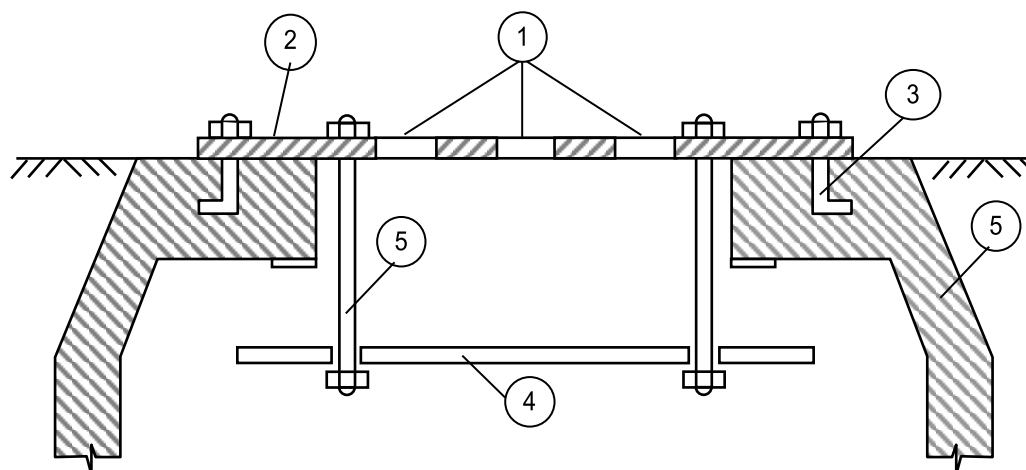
Схема блокирующего устройства: 1 – отверстия для поступления воздуха, стоков; 2 – крышка колодца; 3 – анкерное крепление; 4 – подвижный клапан; 5 – направляющие подвижного клапана
